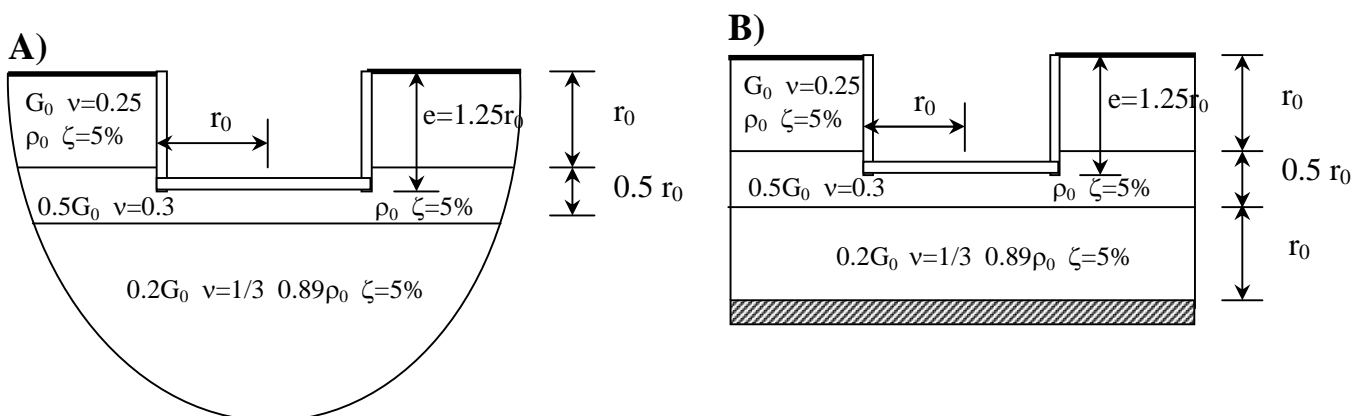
Sols multicouches. A) Fondation cylindrique enterrée dans sol constitué de deux couches sur demi-espace homogène. B) Fondation cylindrique enterrée dans sol constitué de trois couches surmontant un substratum rocheux.
